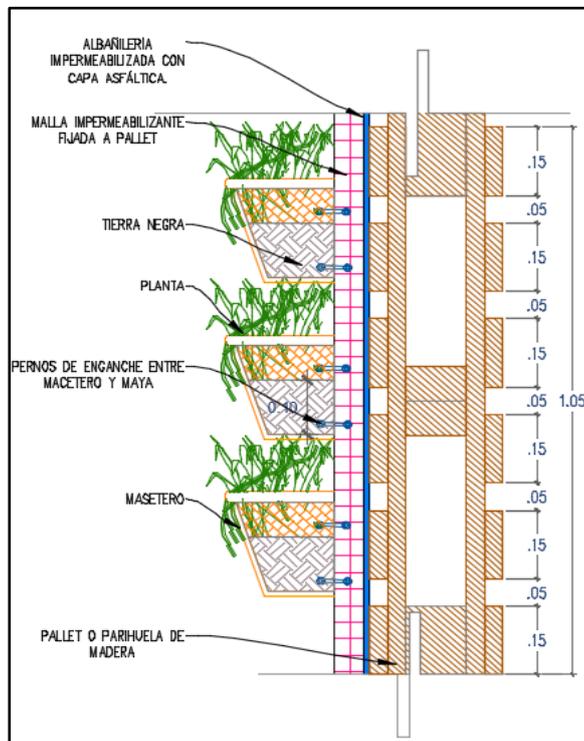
Detalle constructivo de la jardinera vertical en la parihuela o pallet.
